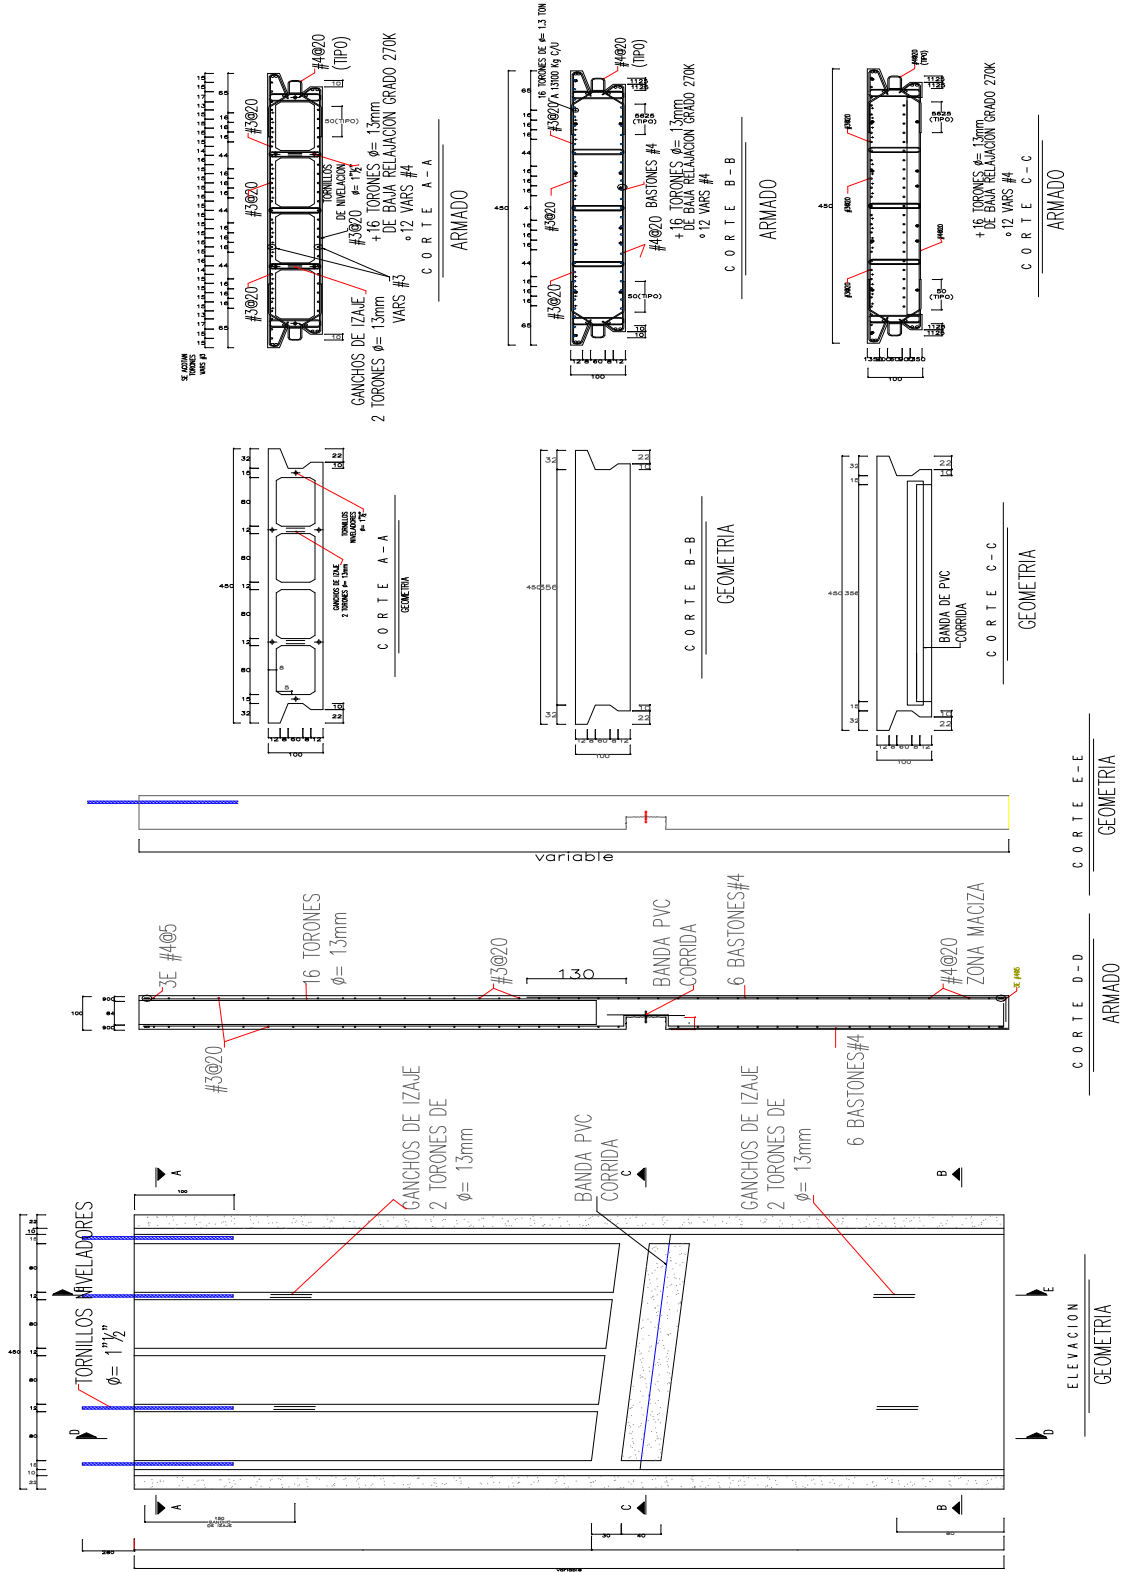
Detalles de construcción de Muro prefabricado para deprimido.
